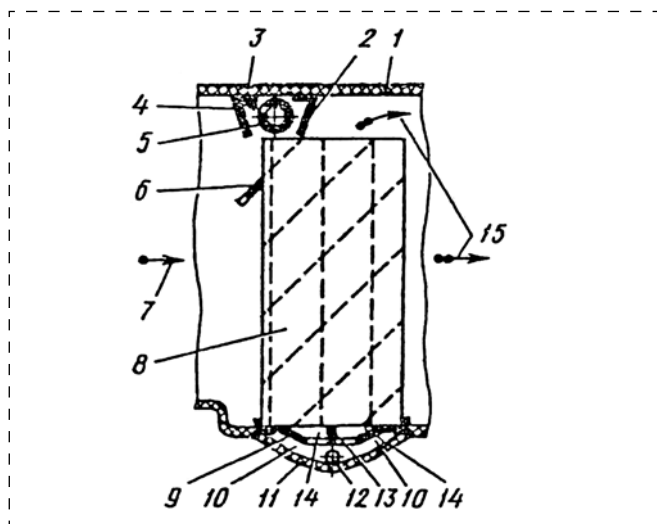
Схема устройства системы орошения усовершенствованной водоиспарительной насадки:
